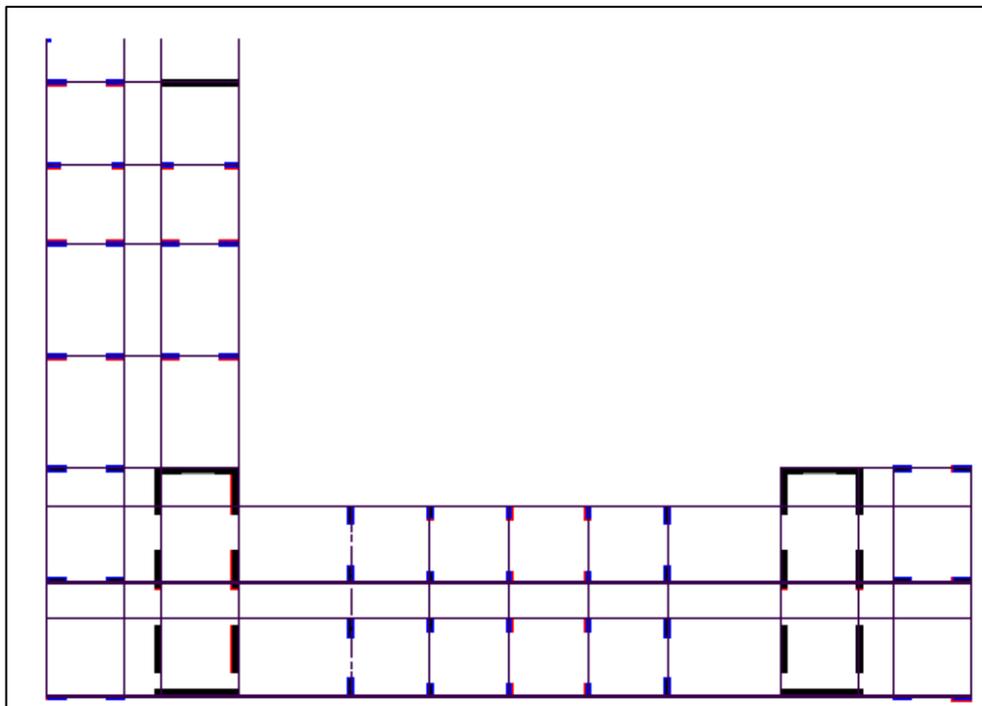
Denah Kolom Gedung Tanpa Dinding Geser 14 Sampai Lantai Atap Tipe A
